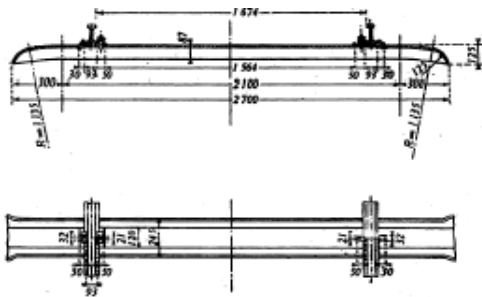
Sección longitudinal y planta de un durmiente metálico.
